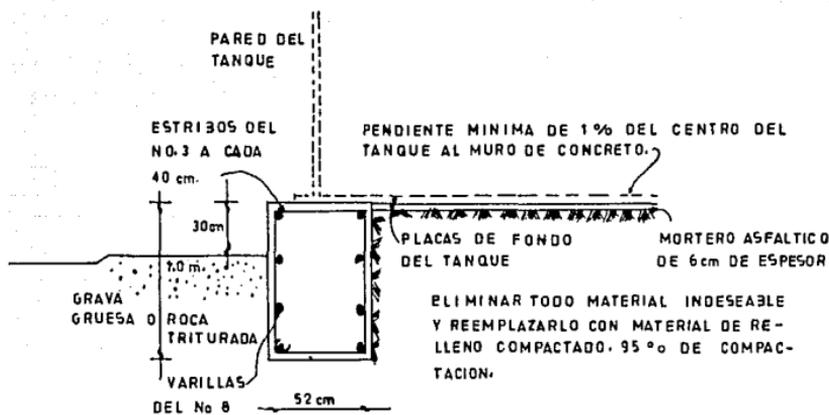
MURO ANULAR DE CONCRETO ARMADO
